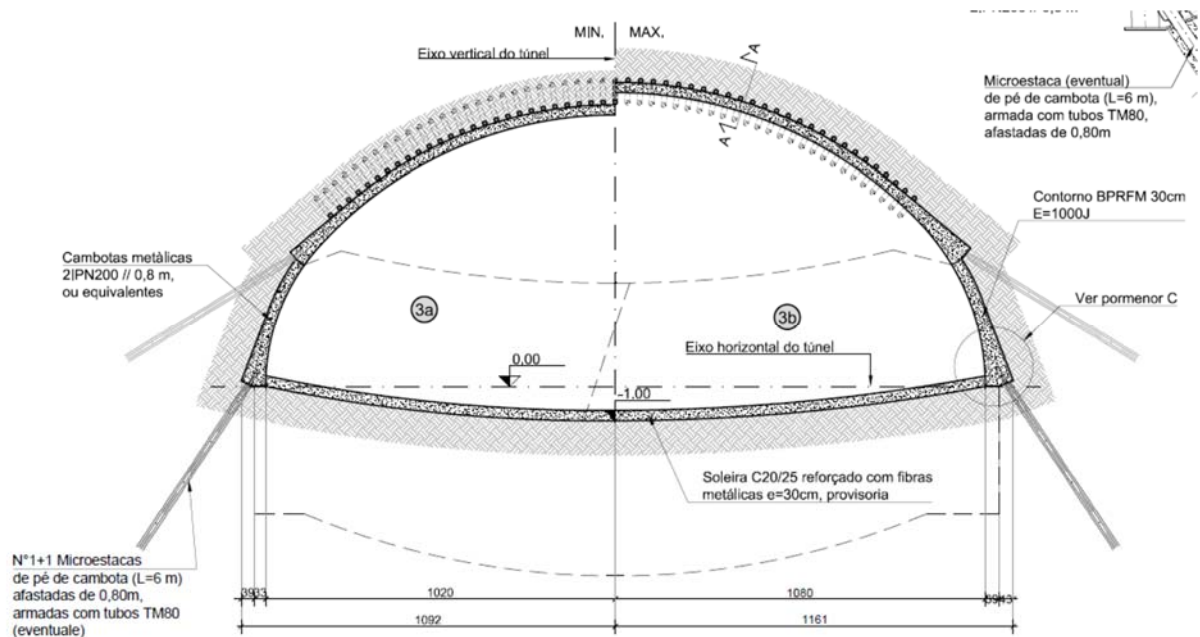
Seção tipo da fase 3 – calote inferior - escavação e suporte primário em ZG3
